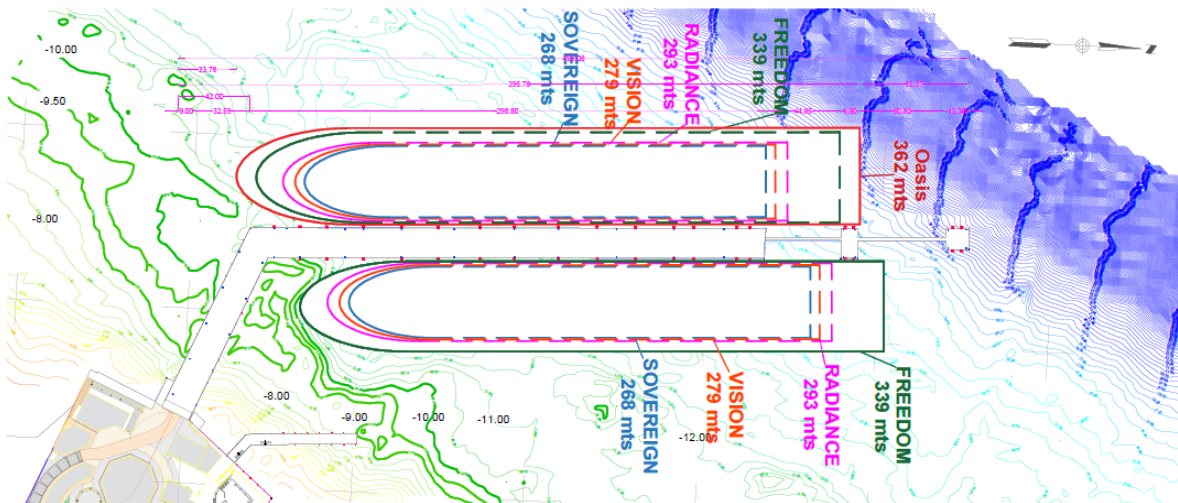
Vista en planta del estado actual de operación del muelle con dos posiciones.
